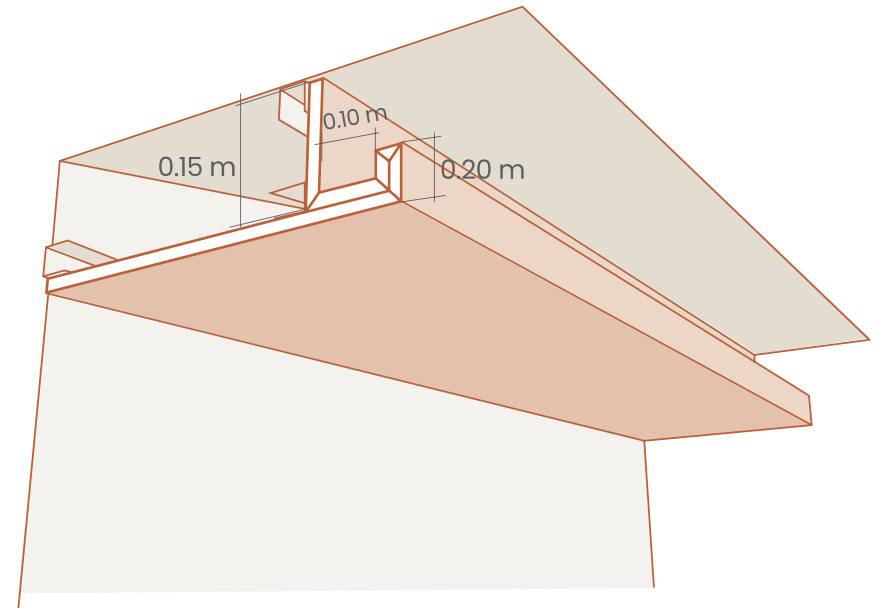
Detalle de cenefas | Fuente: Elaboración propia
